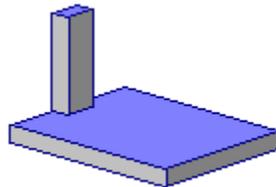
Zapata Aislada, Concreto, Cuadrada, Sección Constante, Colindante
